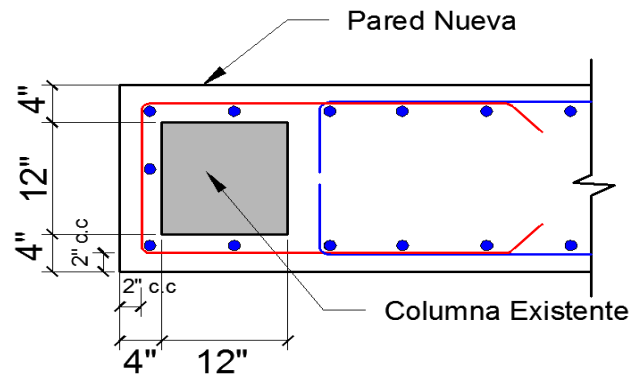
Pared Nueva Abrazando Columna Existente de 12" x 12"
